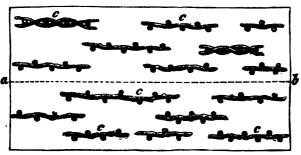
Grundriß einer Sawinenverbauung mit Holg. ab Abbruchslinie. c Pfahlreihen, im Berband angelegt.
